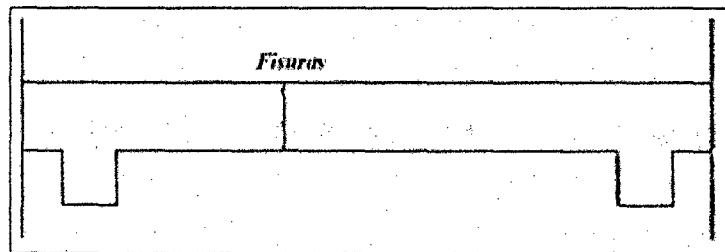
17. Fisuración transversal en losas debido a la retracción hidráulica del concreto. Fuente: (Stuardo P., 2008)
